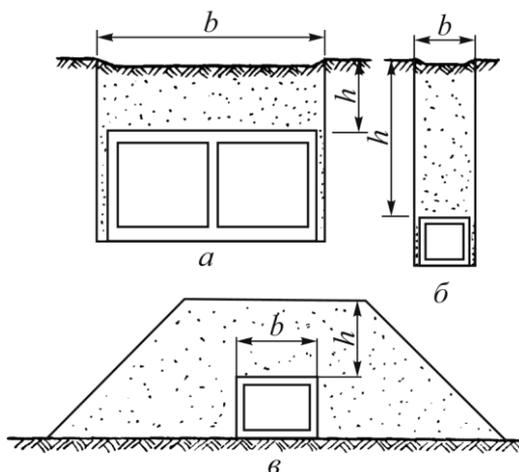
Схемы к определению вертикального давления грунта [4]
